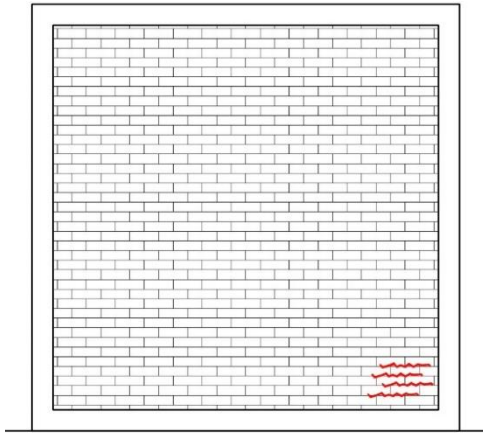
Se muestra la falla por flexión provocada por tensiones en los elementos de confinamiento.
